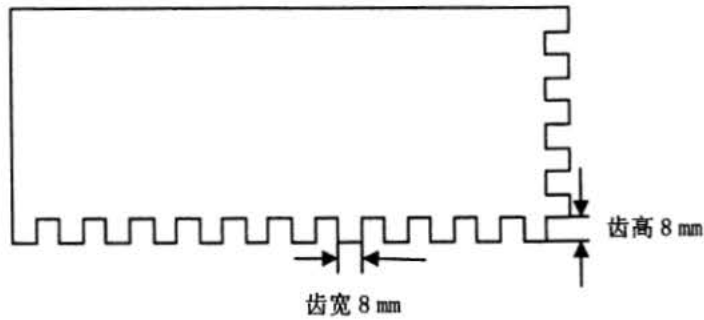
齿宽 8 mm 的齿形抹刀施工面示意图
